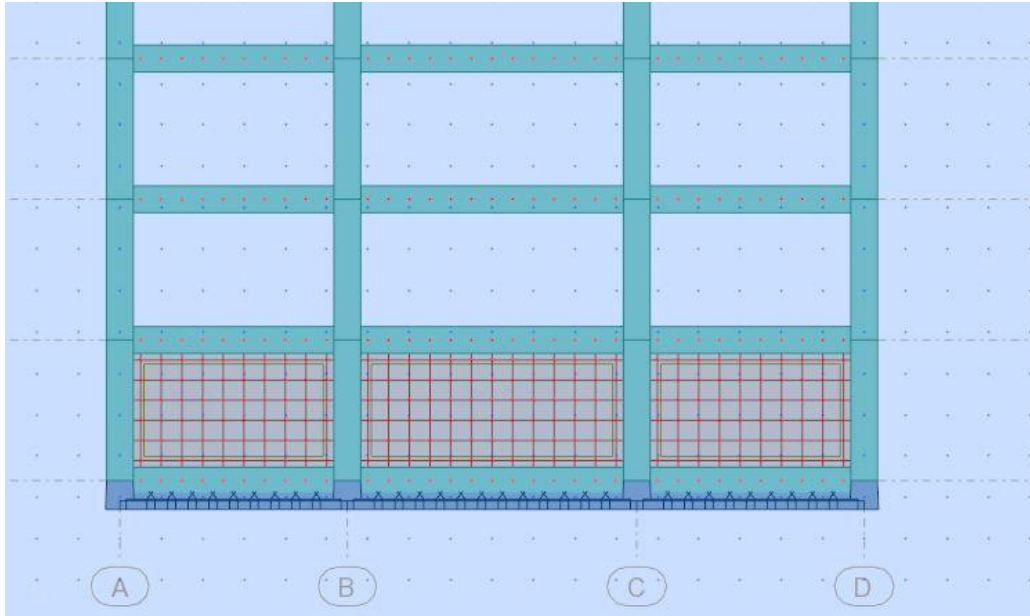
schéma des voiles périphériques longitudinales avec les poteaux et les poutres
